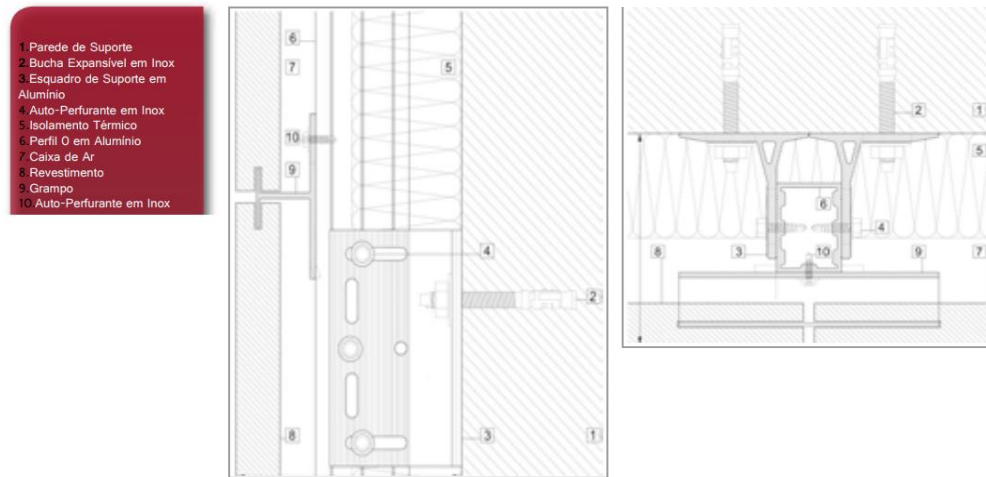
Corte vertical e horizontal fachada ventilada [29]
